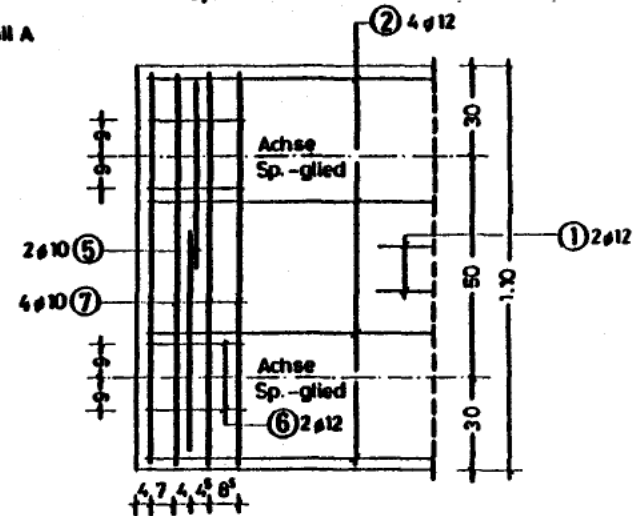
Bewehrungsplan für die schlaffe Bewehrung
